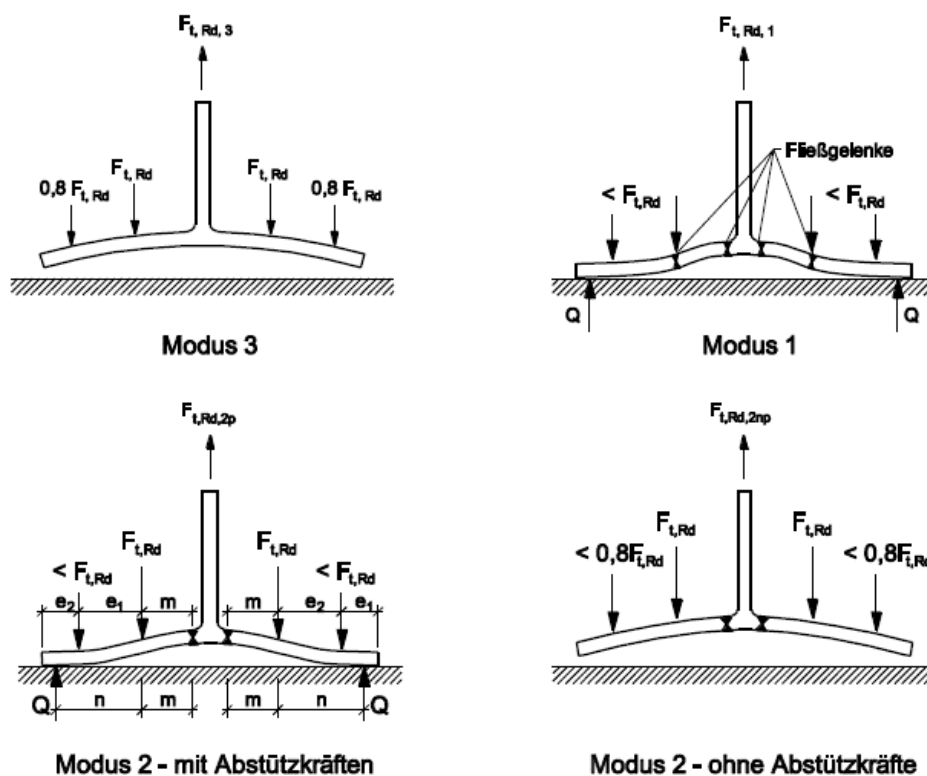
Versagensmechanismen des T-Stummels mit 4 Schrauben in einer Reihe [19]
